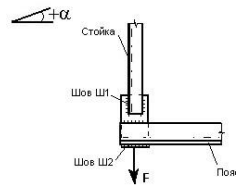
Конструкторский чертеж узла номер 1
